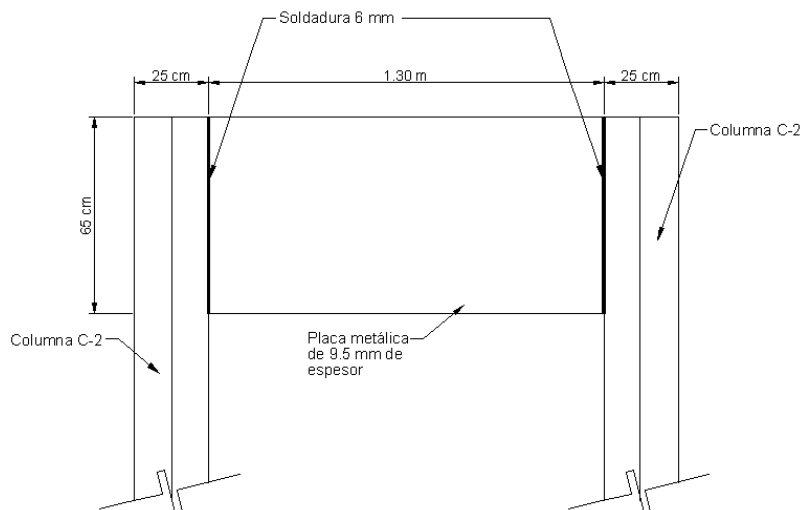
Contraventeo en nudo de columna principal (vista en alzado)
